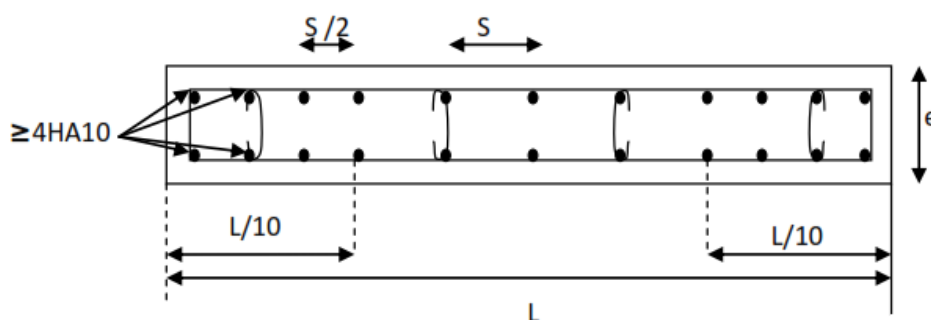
Disposition des armatures verticales dans les voiles.
